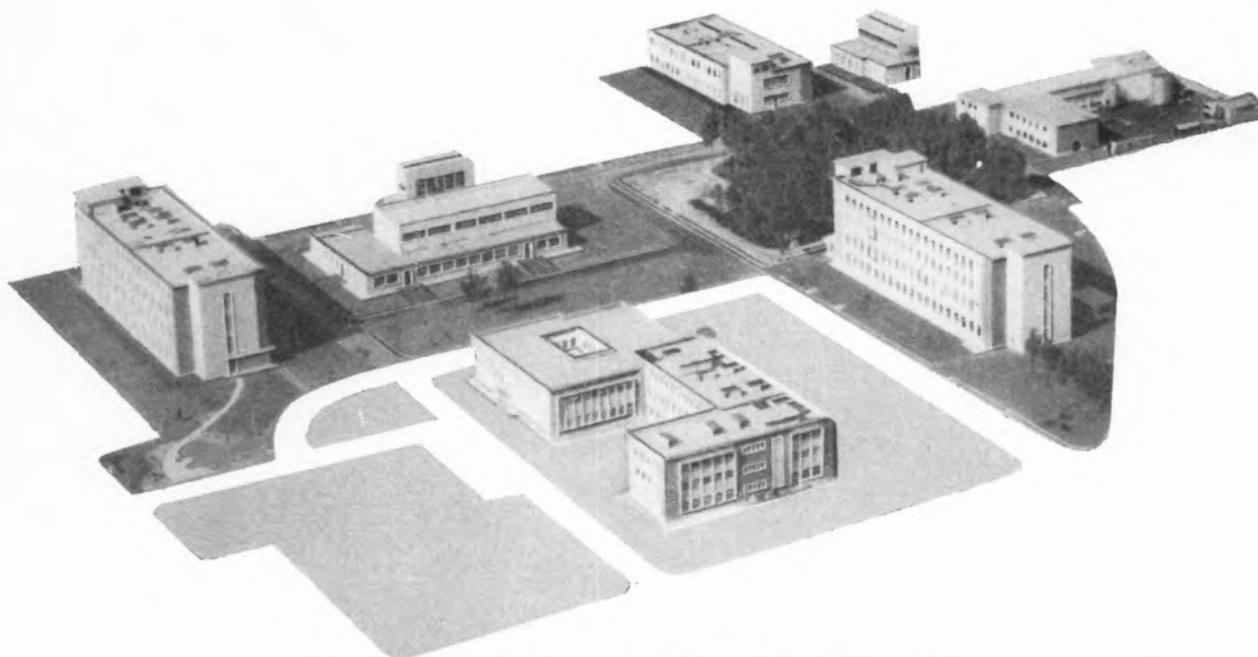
Centro de Investigação de Carrières da Rhône-Poulenc
